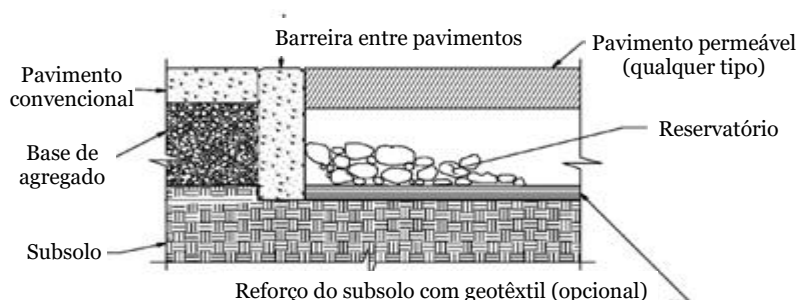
Secção típica de pavimentos permeáveis e convencionais (Adaptado de Caltrans, 2014)
